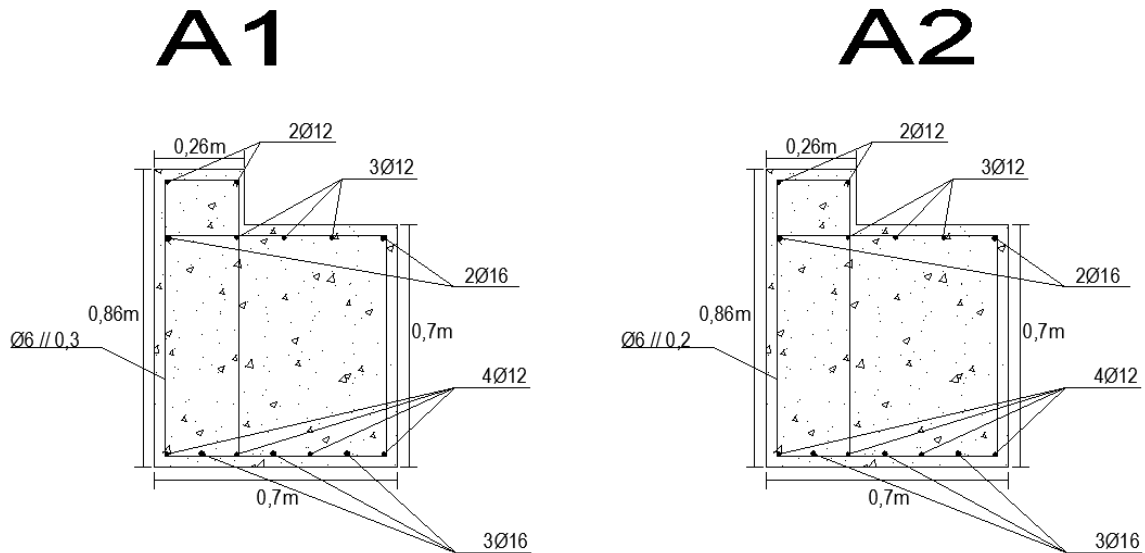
Corte transversal da viga de fundação do pórtico 1-1'
